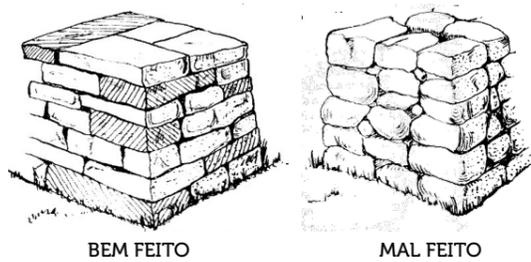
Pormenor do canto ou "Cabeça" do muro, bem construído (do lado esquerdo) e mal construído (do lado direito).
